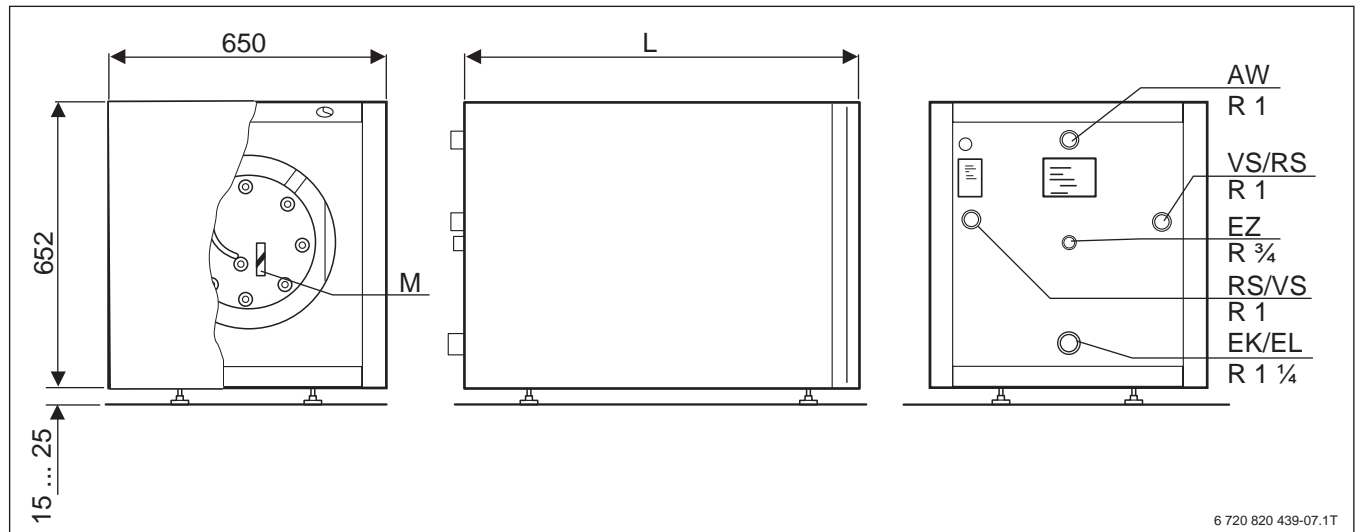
Abmessungen und Anschlüsse (Maße in mm)
